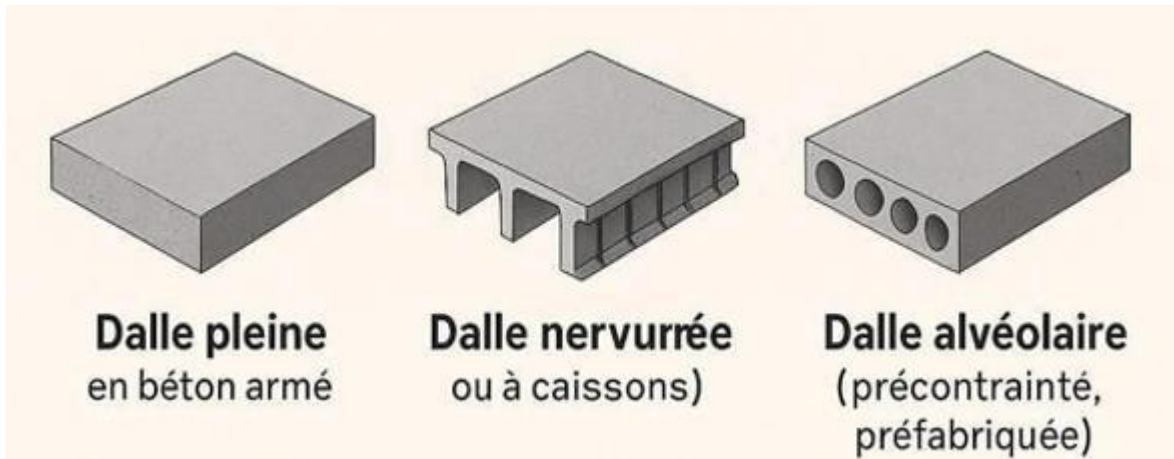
Différents types de dalles préfabriquées en béton[7].
